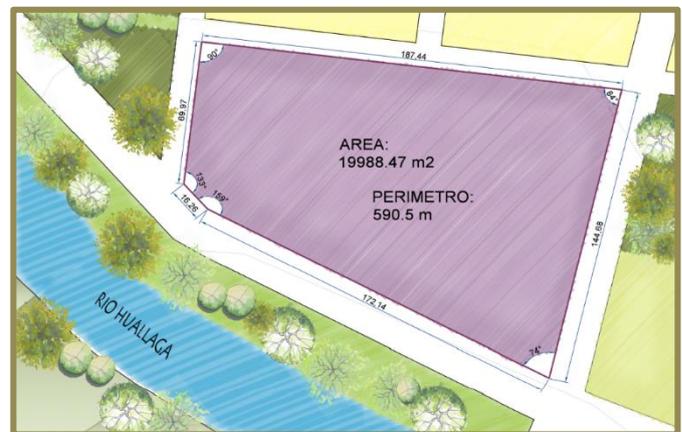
Vista de la forma del terreno para el proyecto.
